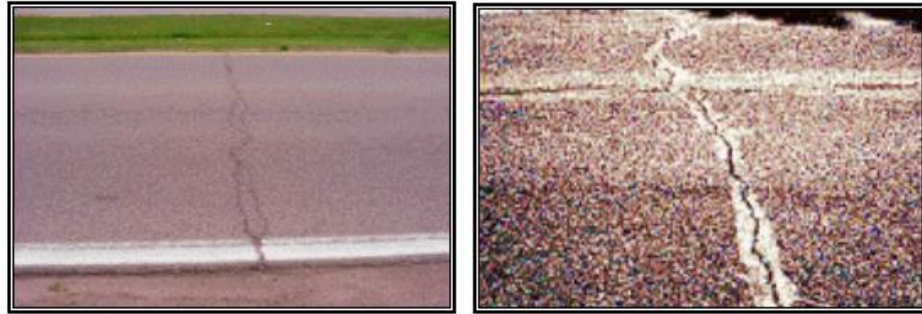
Agrietamiento y fisuras en los pavimentos asfálticos.
